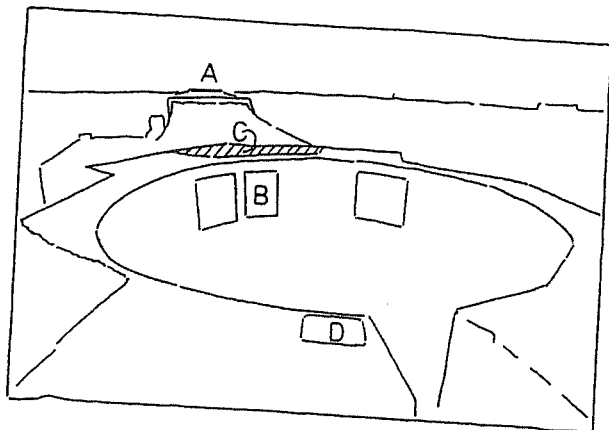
Overzicht van gebouw 069 gezien naar het zuid-westen. Dit bakstenen gebouw met betonnen dak, is gebouwd door de Nederlanders in 1939 en door de Duitsers verbouwd tot vuurleidingspost. Bovenop het gebouw stonden de instrumenten (A) (zie afb. 069.2). Aan de noordzijde is het gebouw voorzien van een bakstenen scherfmuur (B).
